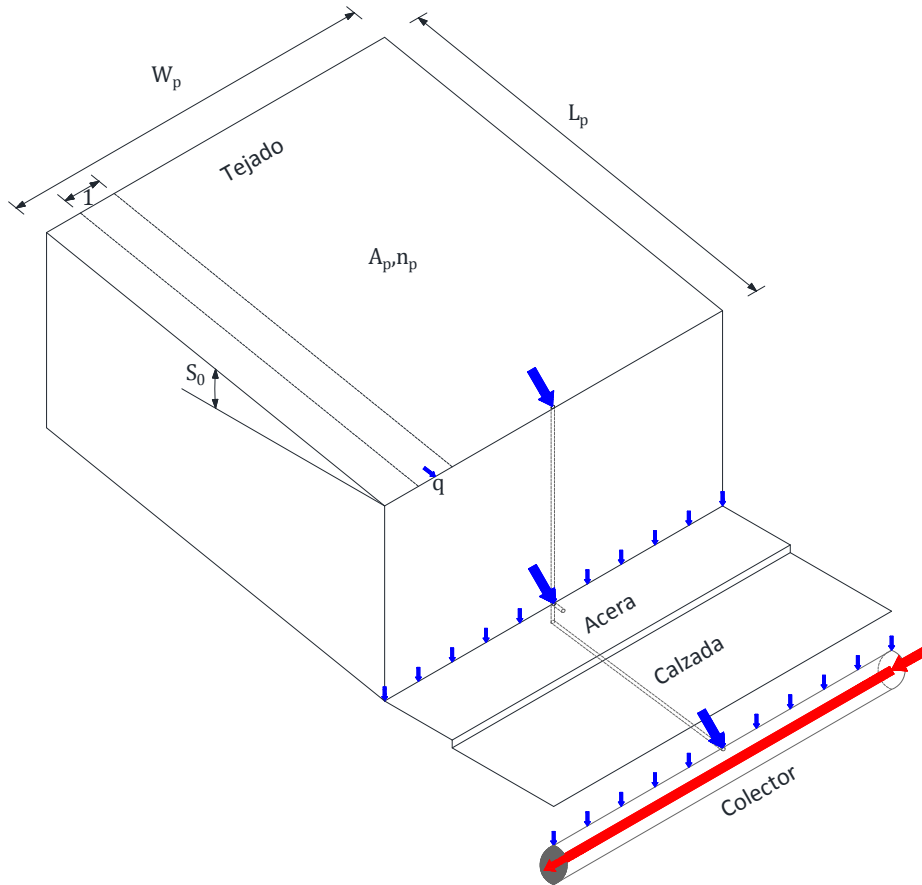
Geometría de un tejado y conexión con otros elementos del drenaje urbano
